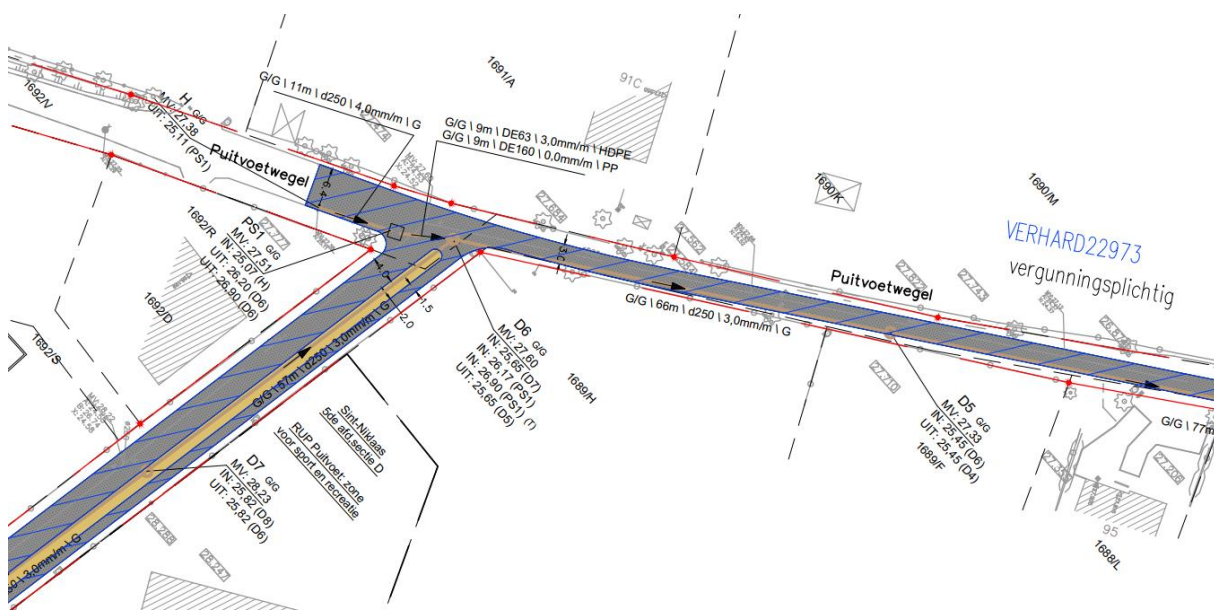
Uitsnede uit doorsnedeplan met ontworpen toestand ter hoogte van het noordelijk deel van Industriepark-West
